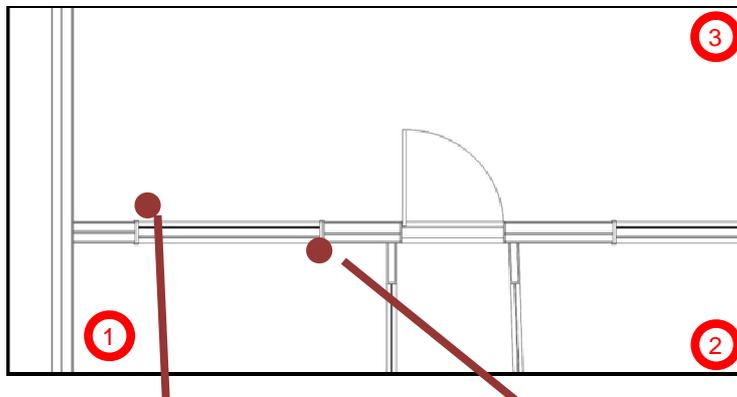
Planta baixa do estúdio da faculdade AESO.
